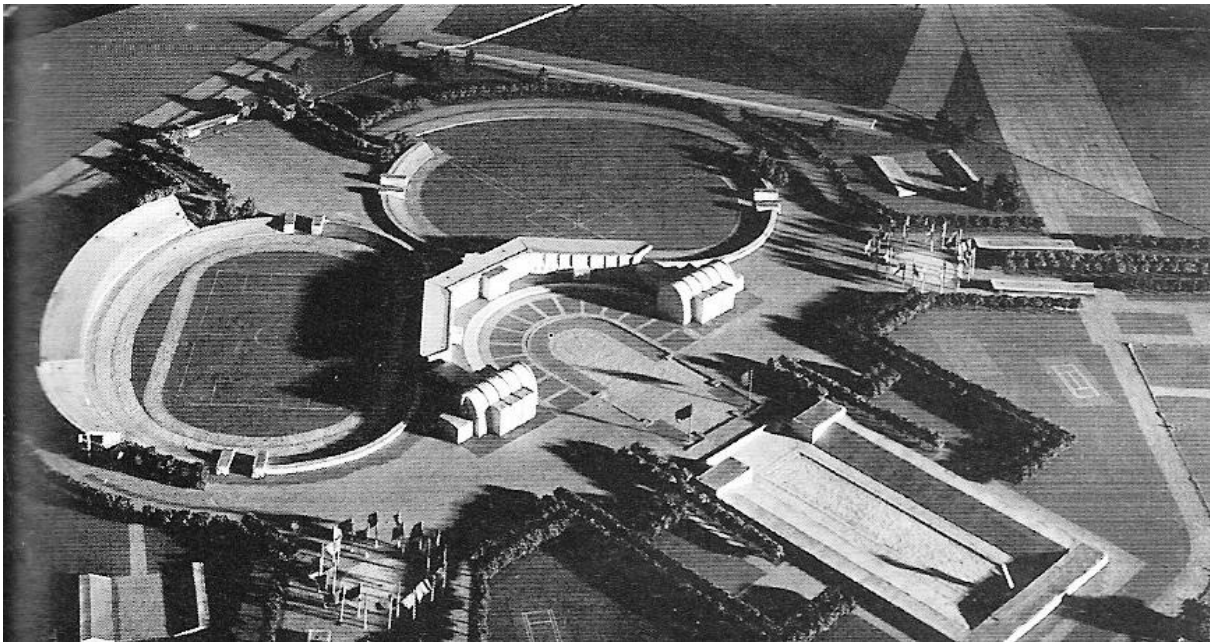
Modell des Sportplatzes der Universitätsstadt. In Rothers ersten Projekten für den Campus wurden die neuen Bautechniken des Stahlbetons eingeführt.
